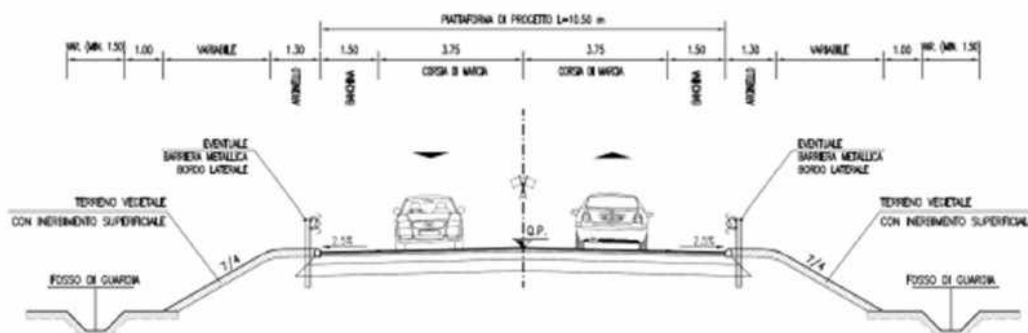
Sezione tipo rampa di svincolo bidirezionale
